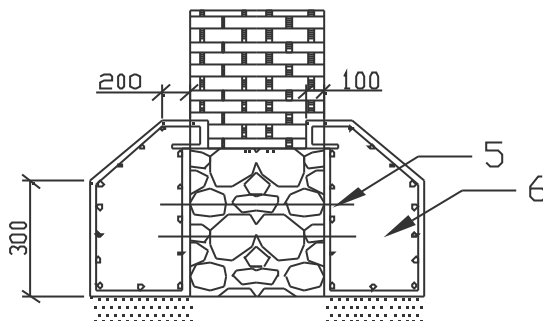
Двухстороннее уширение фундамента железобетонным приливом
